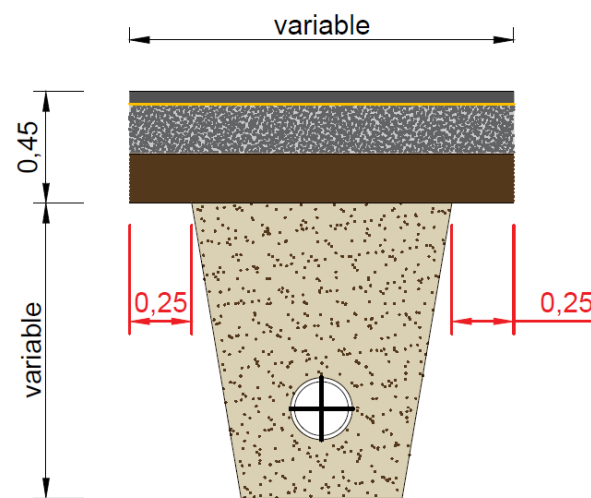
Croquis reposició rasa de servei en zona de calçada.
